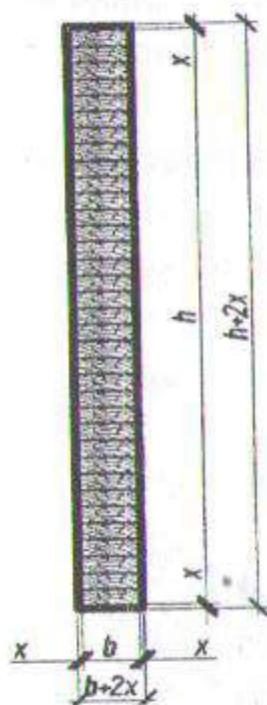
Поперечное сечение, деревоклееной балки с усилением опорной зоны: b – ширина балки, см; h – высота балки, см; x – толщина усиления, см
